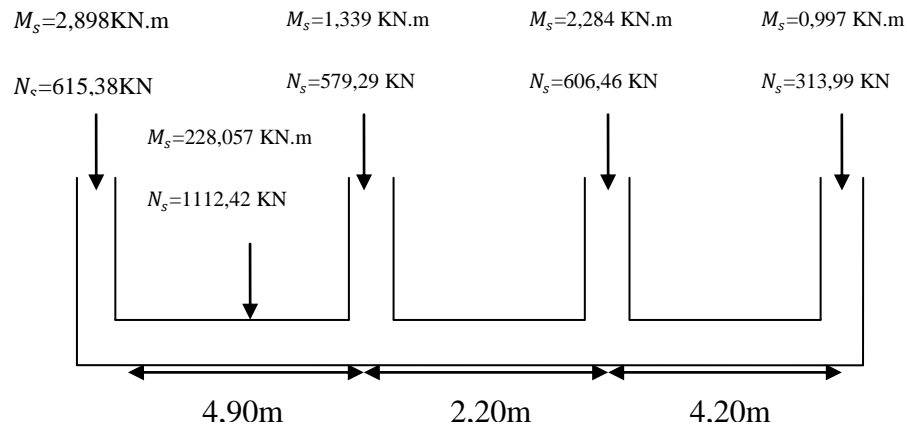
Chargement de la semelle filant a L' ELS.
